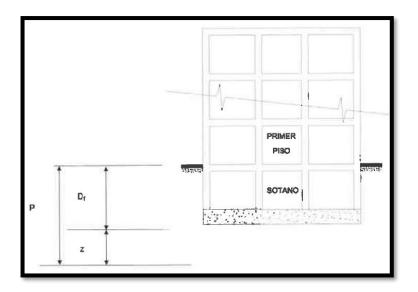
Profundidad de cimentación para una edificación con sótano (platea de cimentación).
